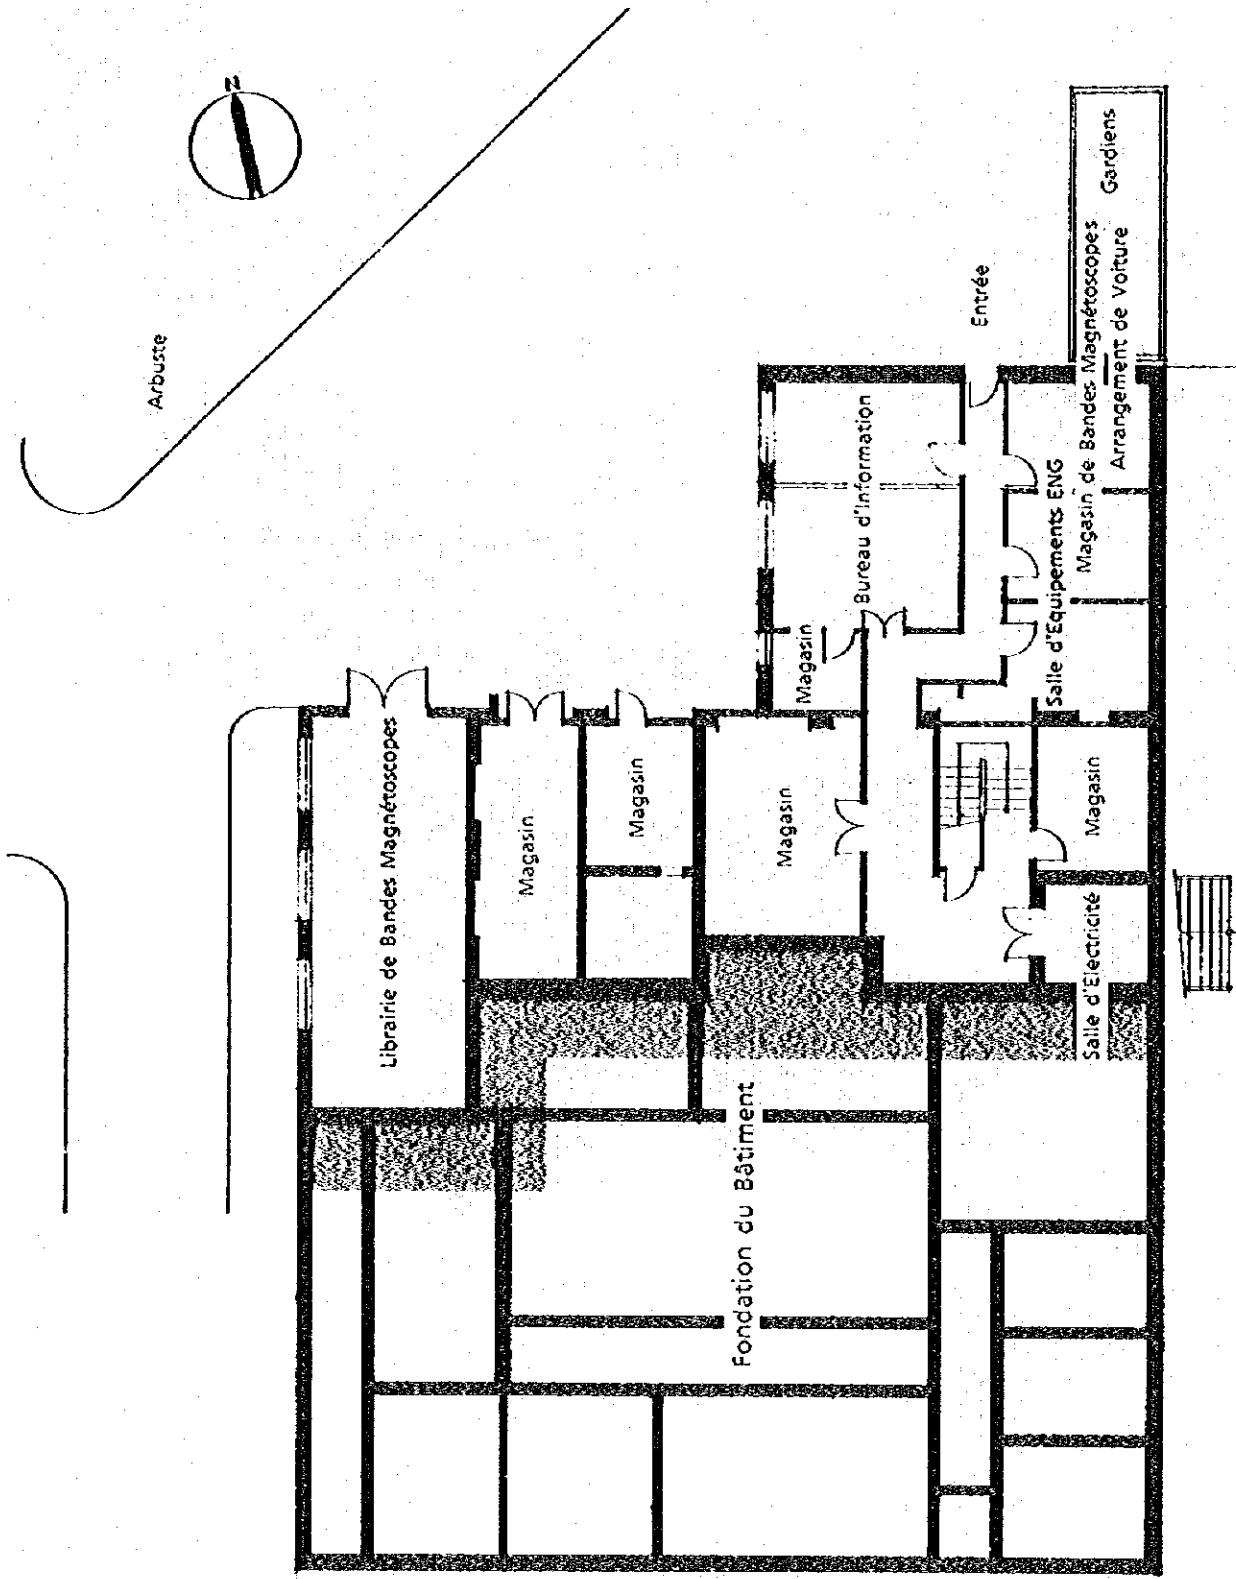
PLAN DU REZ DE CHAUSSEE DU BATIMENT EXISTANT
